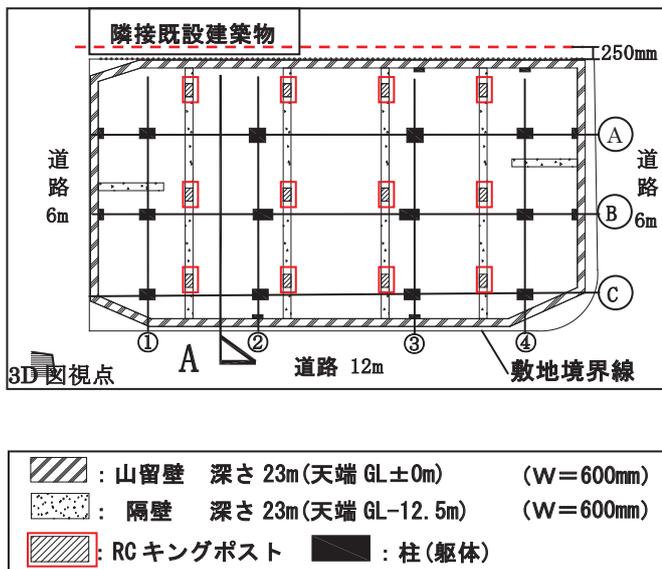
山留め地中連続壁配置平面図 <VE案>
